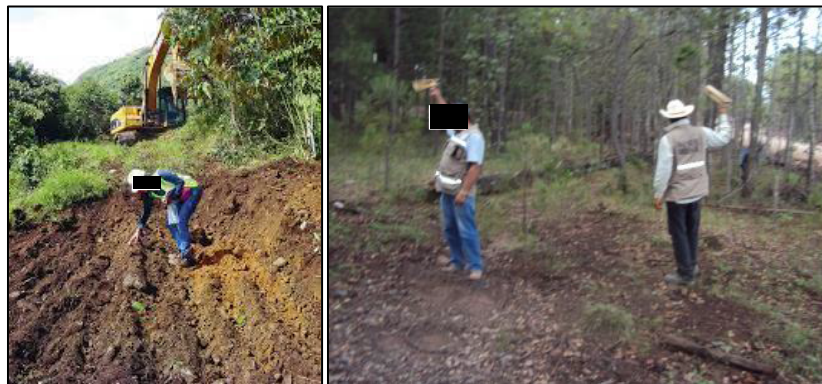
Ejemplo de ahuyentamiento de aves en obras similares.
